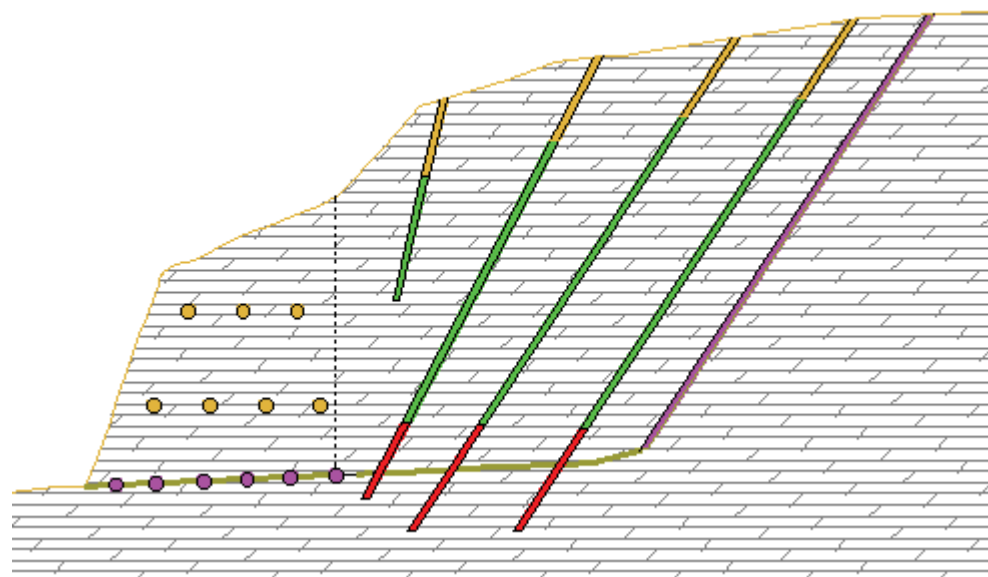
Voladura tipo en el tramo situado entre los PP.KK. 0+143 y 0+155
